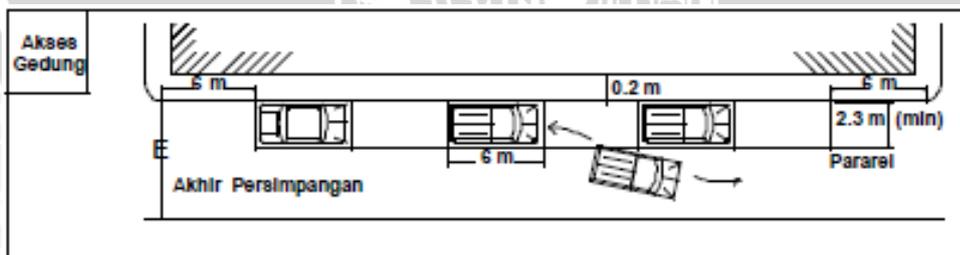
5 Ruang Parkir pada Badan Jalan
